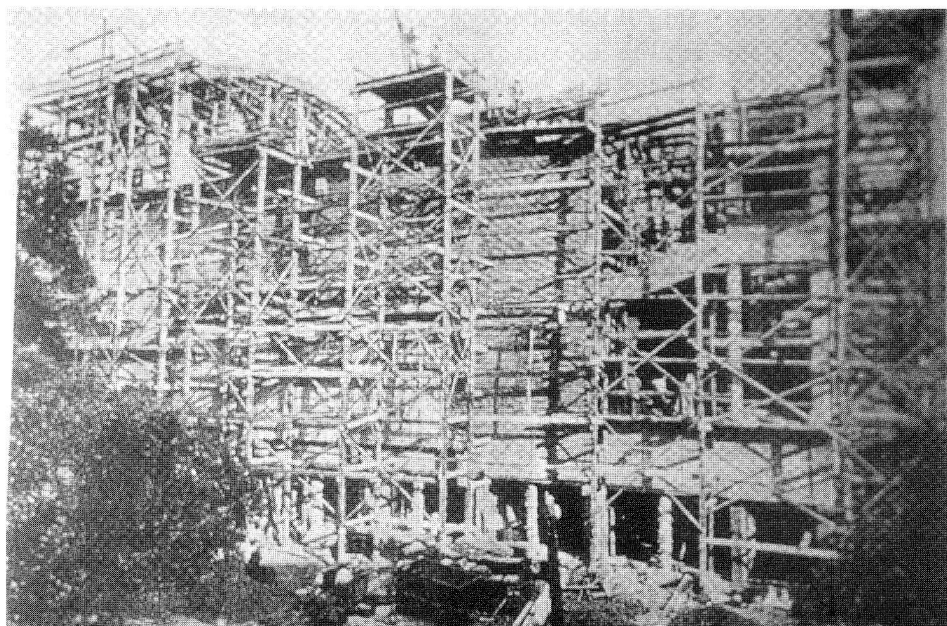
Fachada del Teatro Iris en obras (Empresa Parra).
